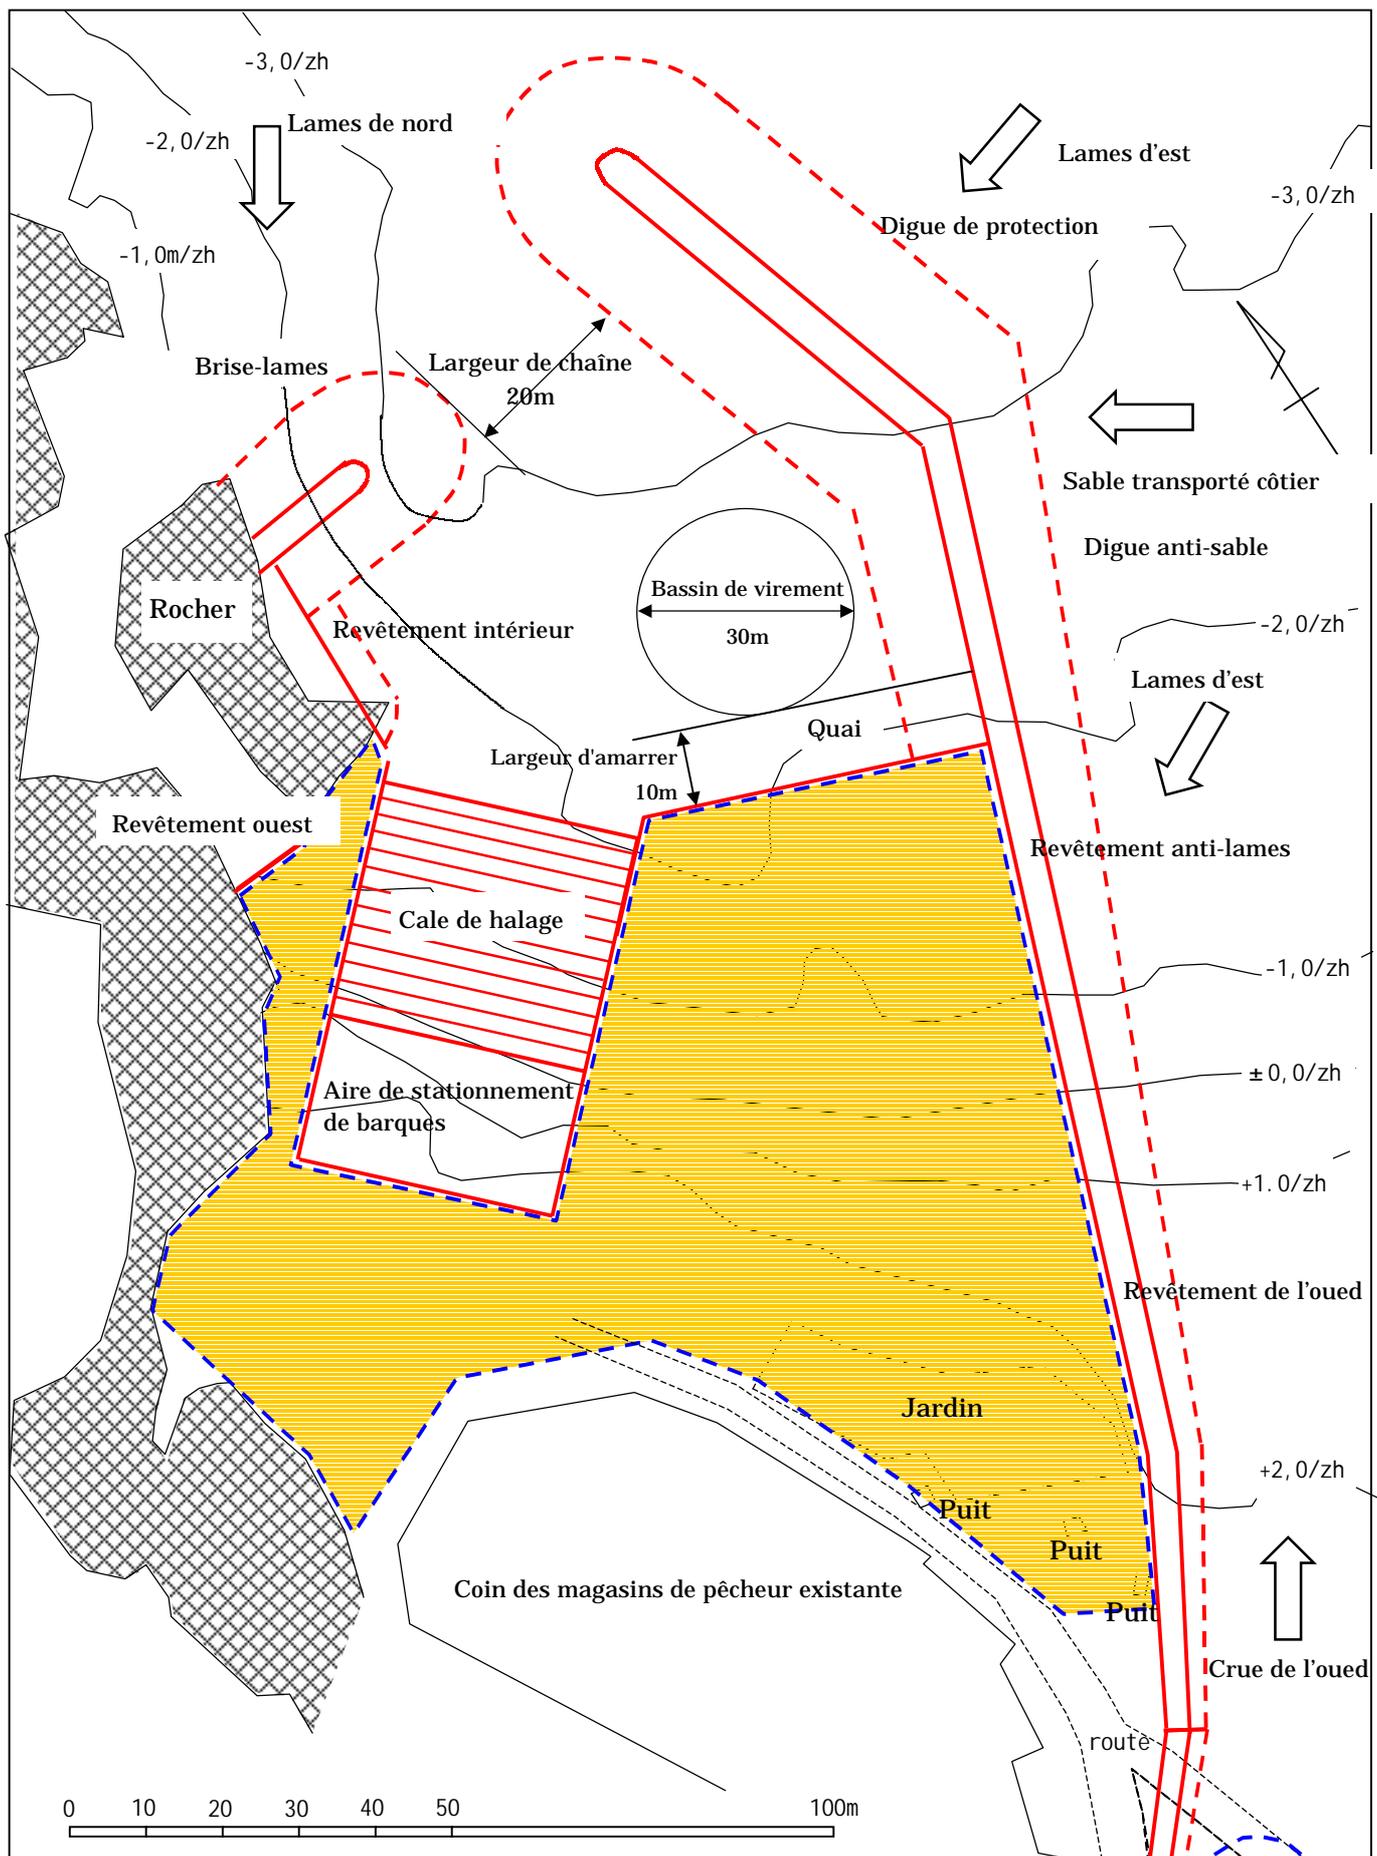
Concept du plan d'ensemble des installations portuaires
